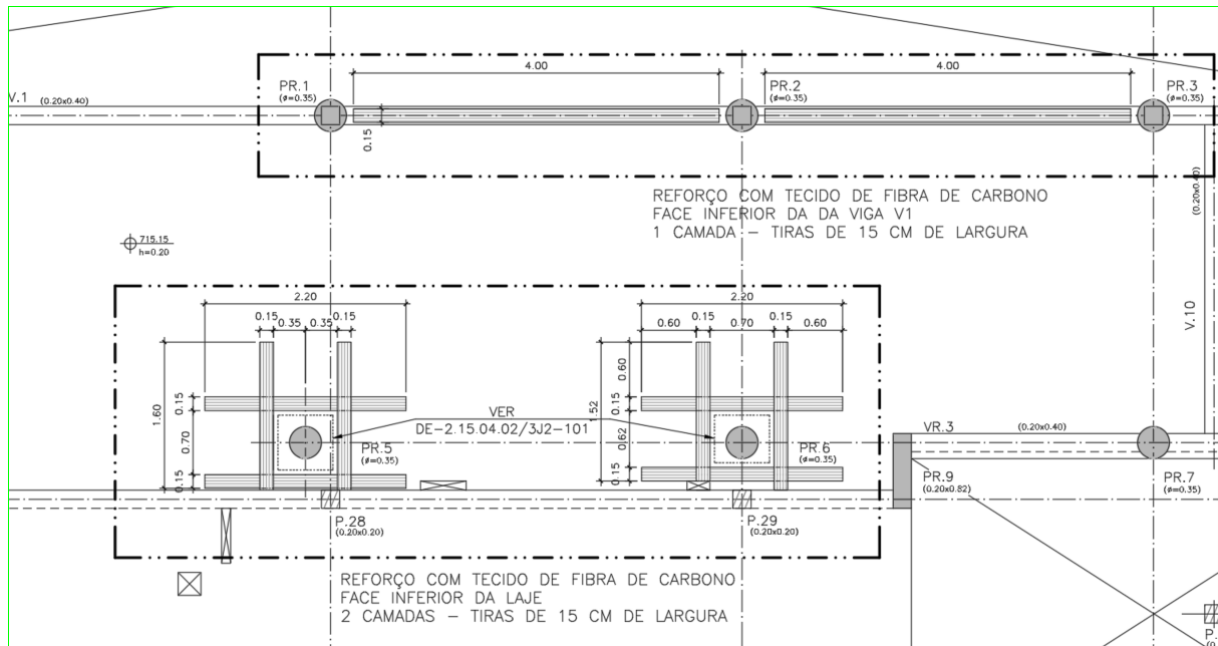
Exemplo de reforço com fibra de carbono em viga e laje.
